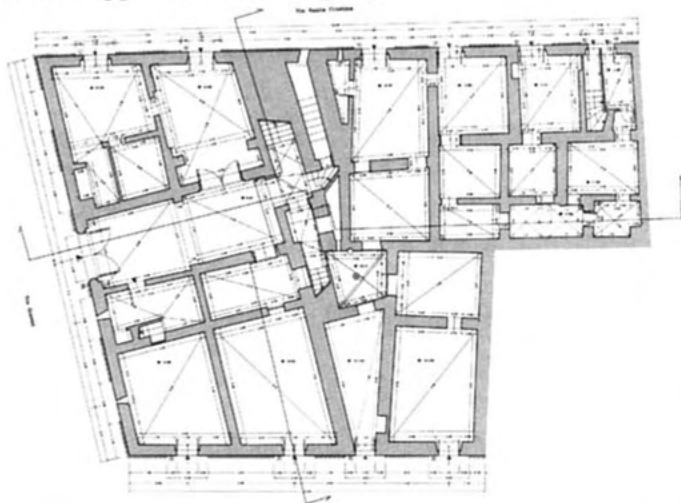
Fabrizio Avella, Francesco Maggio, Antonio Orlando, Mario Treccarichi, pianta quotata del piano terra di un edificio ottocentesco di Palermo. Il piano di sezione è orizzontale e parallelo al quadro di rappresentazione.
